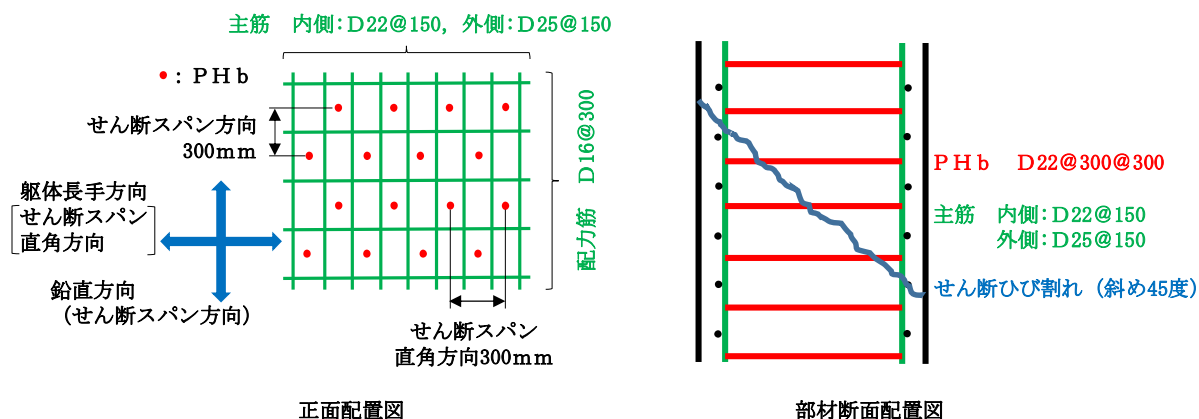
東海第二発電所 取水構造物（側壁）のせん断補強筋正面配置図及び部材断面配置図
